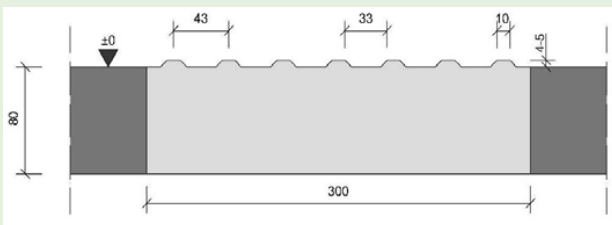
Querschnitt Rippenplatte für Richtungs- und Sperrfeld (beispielhaft)
